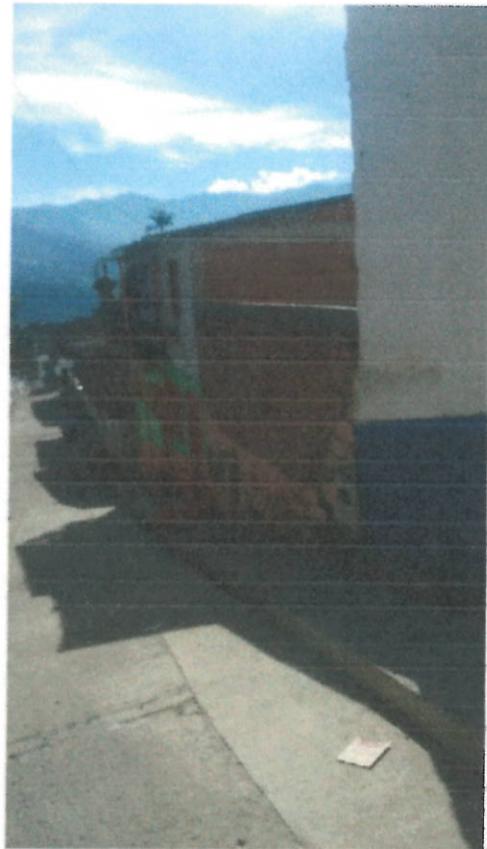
y 9. Vaciado de pavimento en brecha de la calle 2 y construcción de viga en muro.
